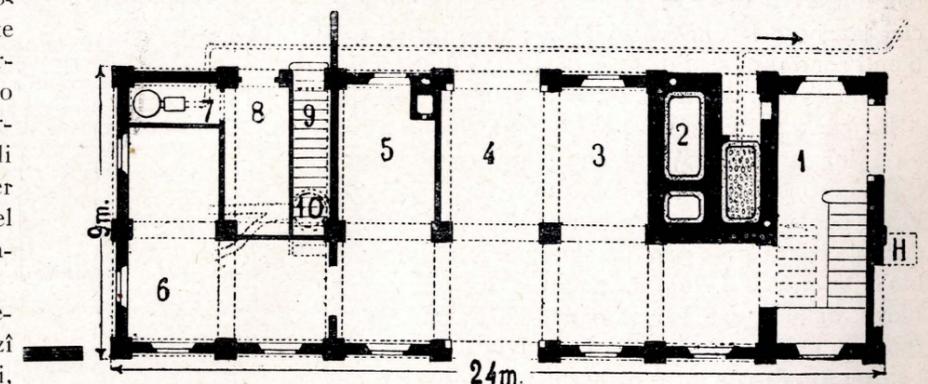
Pianta del piano terreno del nuovo padiglione (Scala 1:200).
